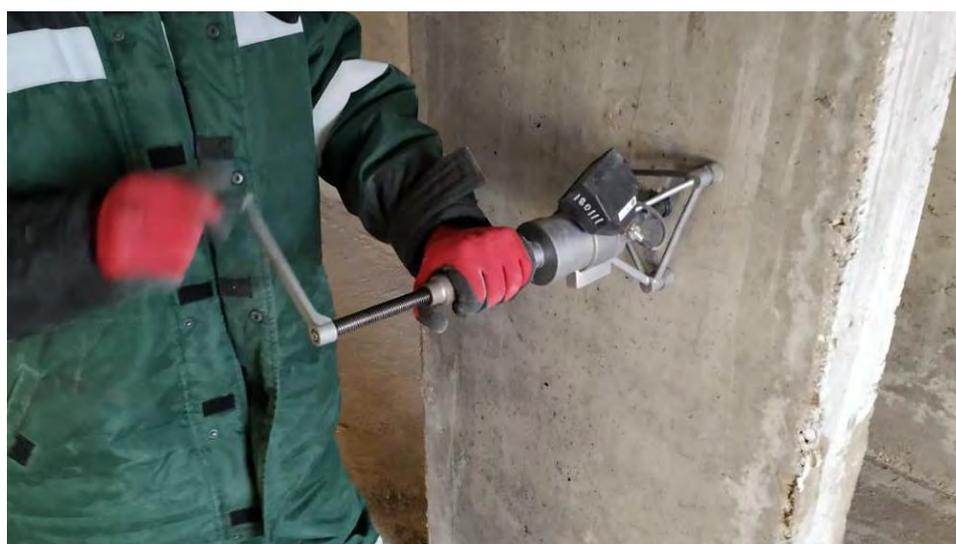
Испытание бетона монолитного железобетонного пилона в осях бс2-7с2/Вс2 методом отрыва со скалыванием прибором ПОС 50МГ-4
